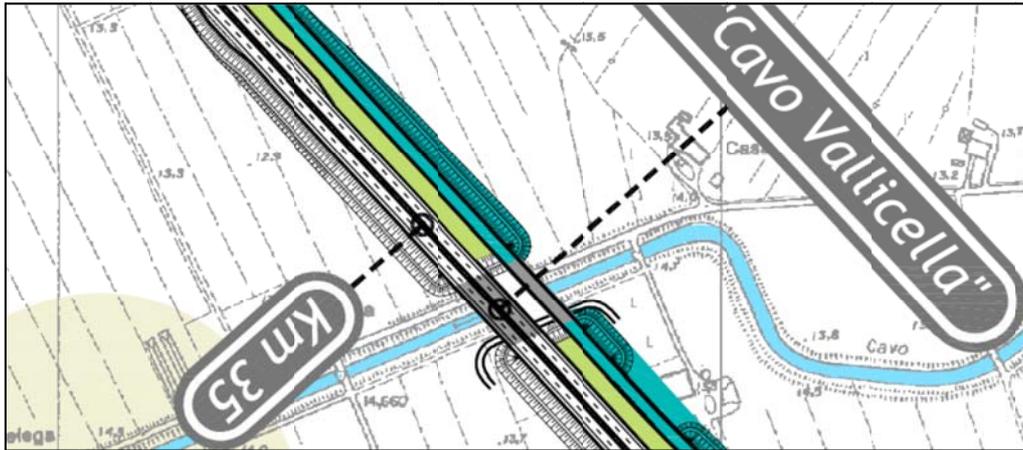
STRALCIO PLANIMETRICO PP
